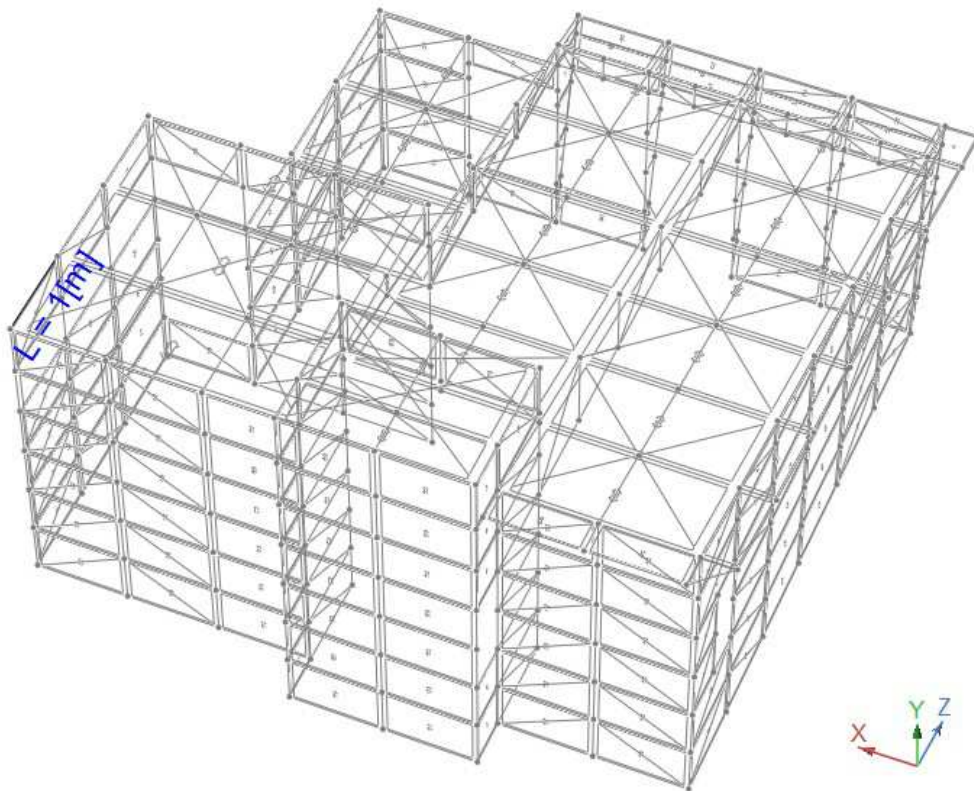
Distribución modular de elementos gravitacionales para posterior bajado de cargas en sistema de muros.
